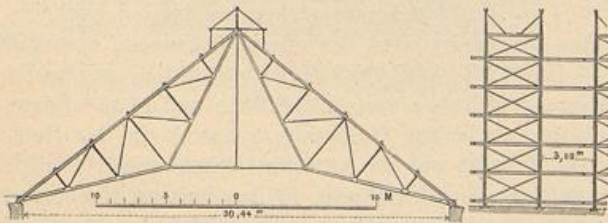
Dachkonstruktion eines Retorten-Gebäudes der städtischen Gasanstalt in der Gitschiner Strasse No. 48.
